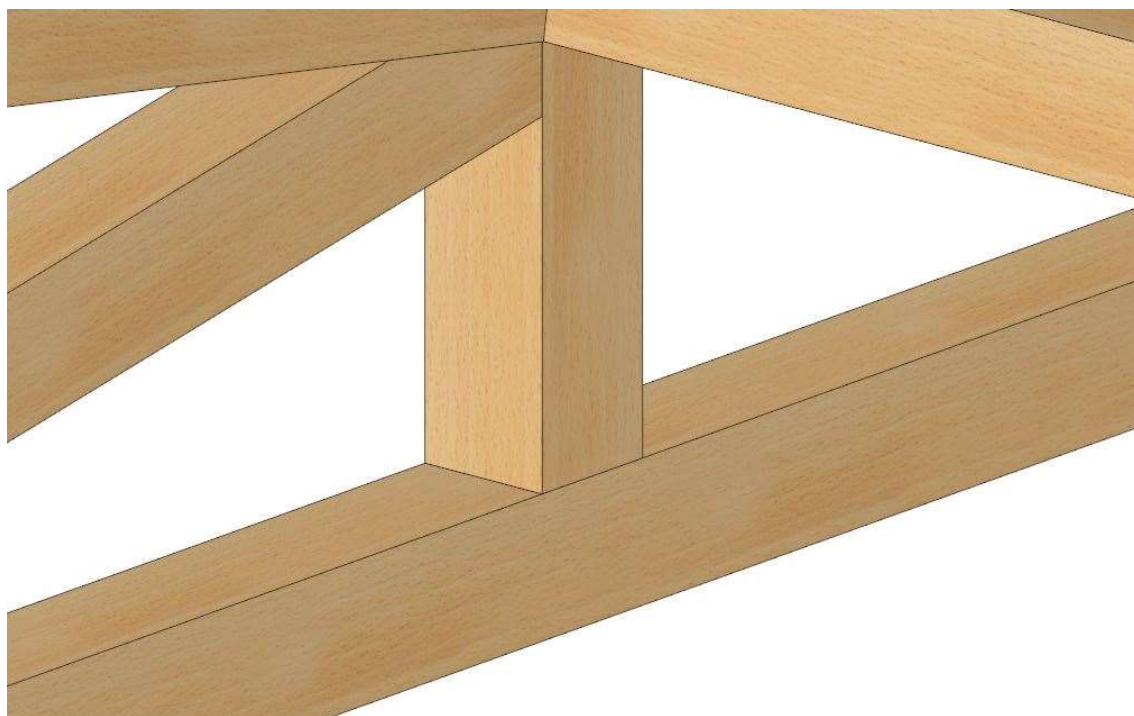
Detalle de unión penúltimo pilar. Pilar-vigas horizontales de la cercha. Viga exterior. Imagen de Cadwork.
